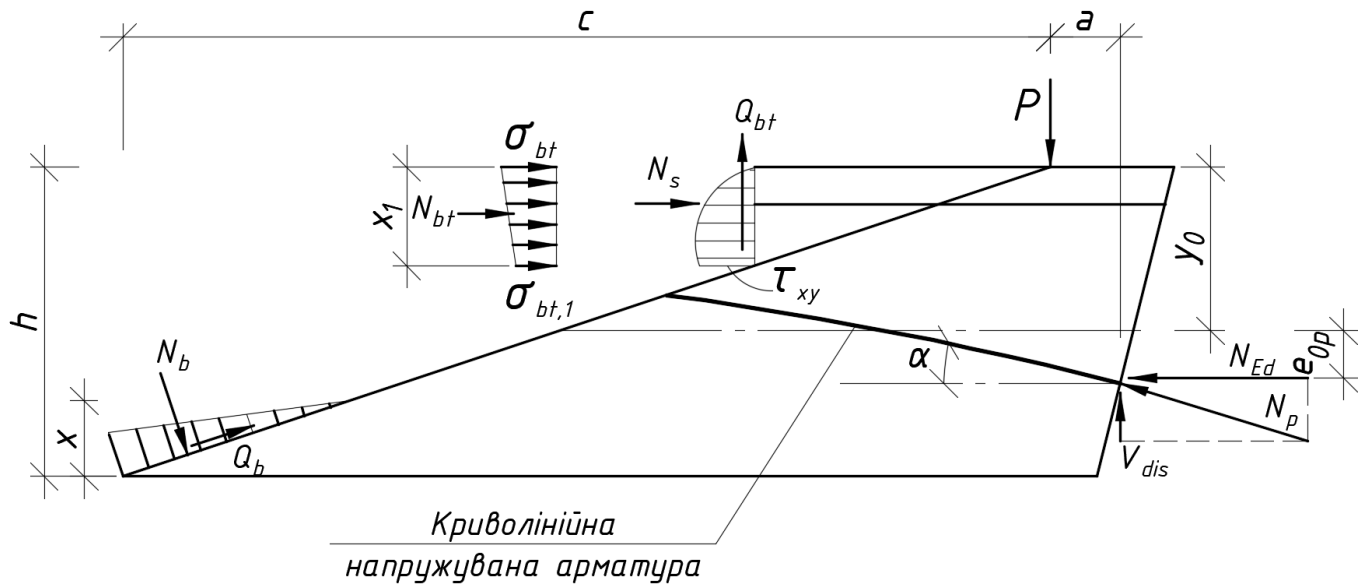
Розрахункова модель граничного стану на стадії утворення похилих тріщин в елементах із криволінійною напружуваною арматурою без зчеплення з бетоном
